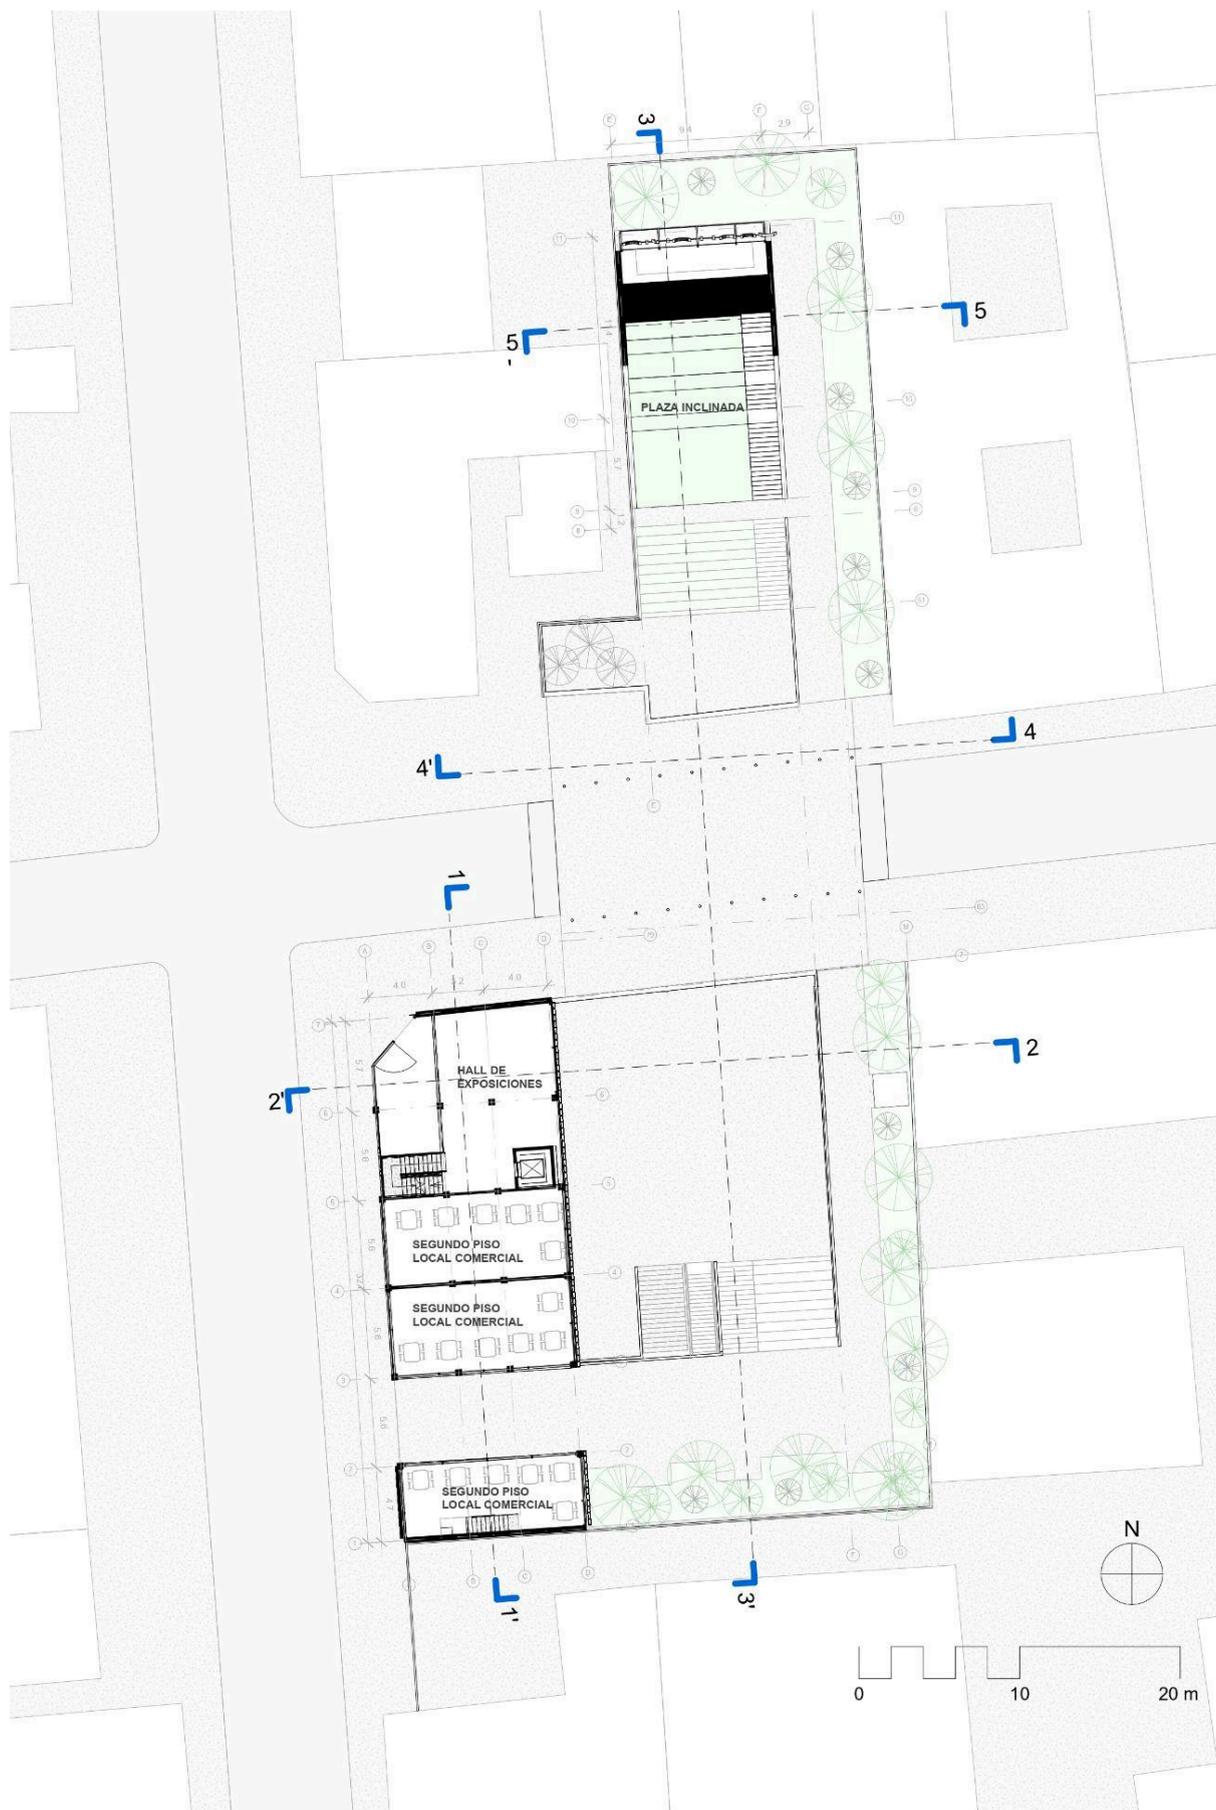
Planta Nivel 2. Fuente: Elaboración propia.
